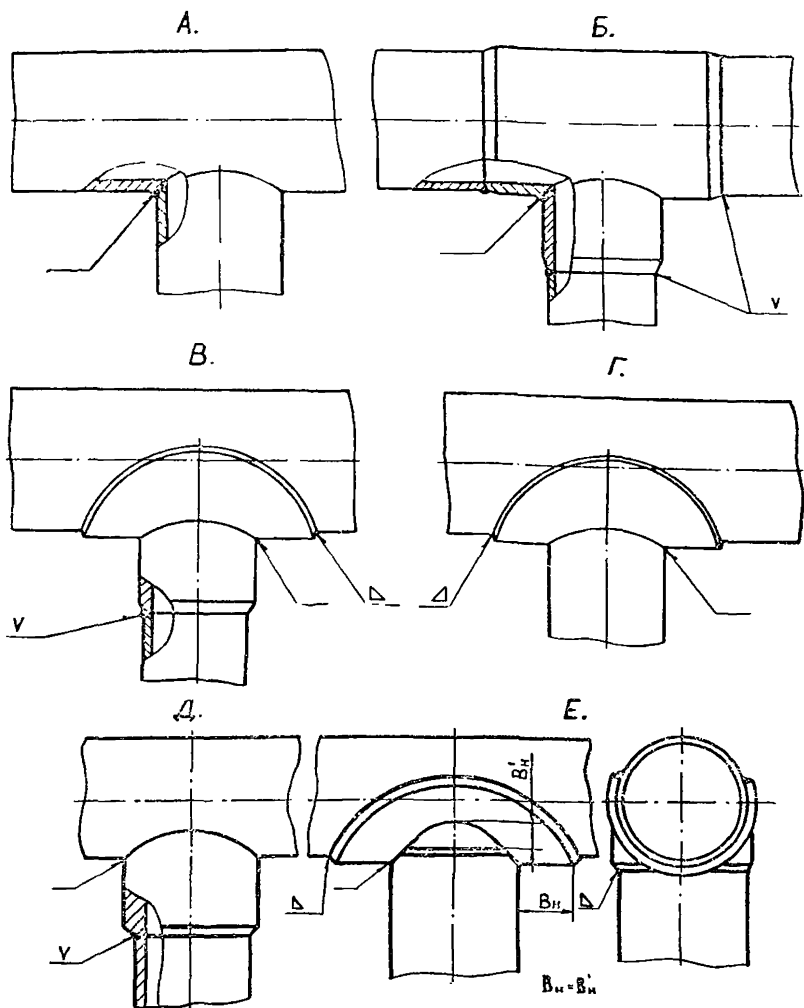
А — непосредственное присоединение труб; Б — присоединение посредством усиленного (штампованного или сварного) тройника; В — присоединение труб с установкой накладки на основной и усиленного штуцера на ответвляемый трубопровод; Г — присоединение труб с установкой накладки на основной трубопровод; Д — присоединение труб с установкой усиленного штуцера; Е — присоединение труб с установкой накладок на основной и ответвляемый трубопроводы.
